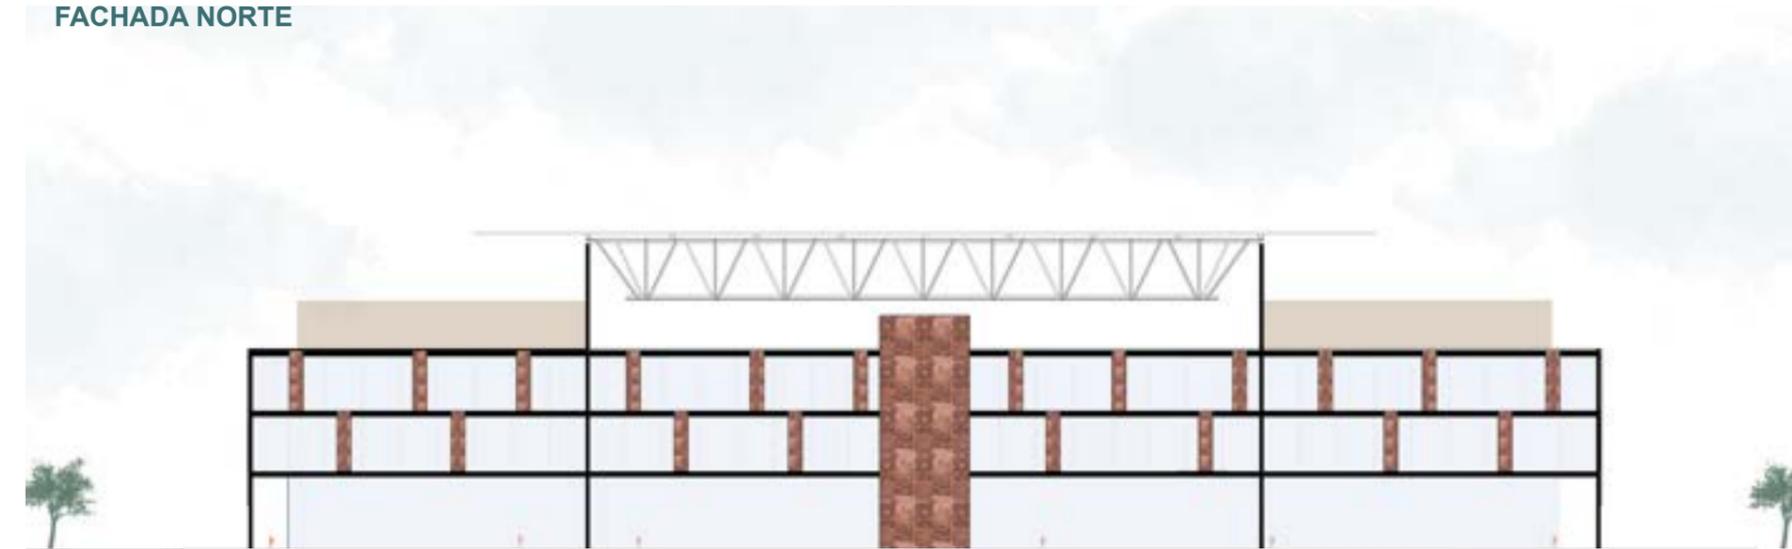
Fachada Norte. Fonte: Autoria própria
